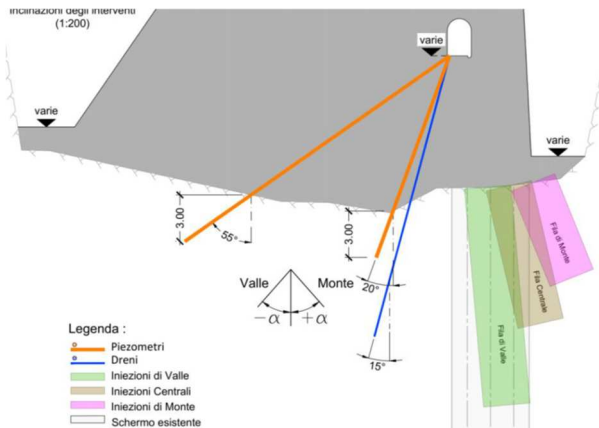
Nuovi dreni in fondazione – Sezione tipo
